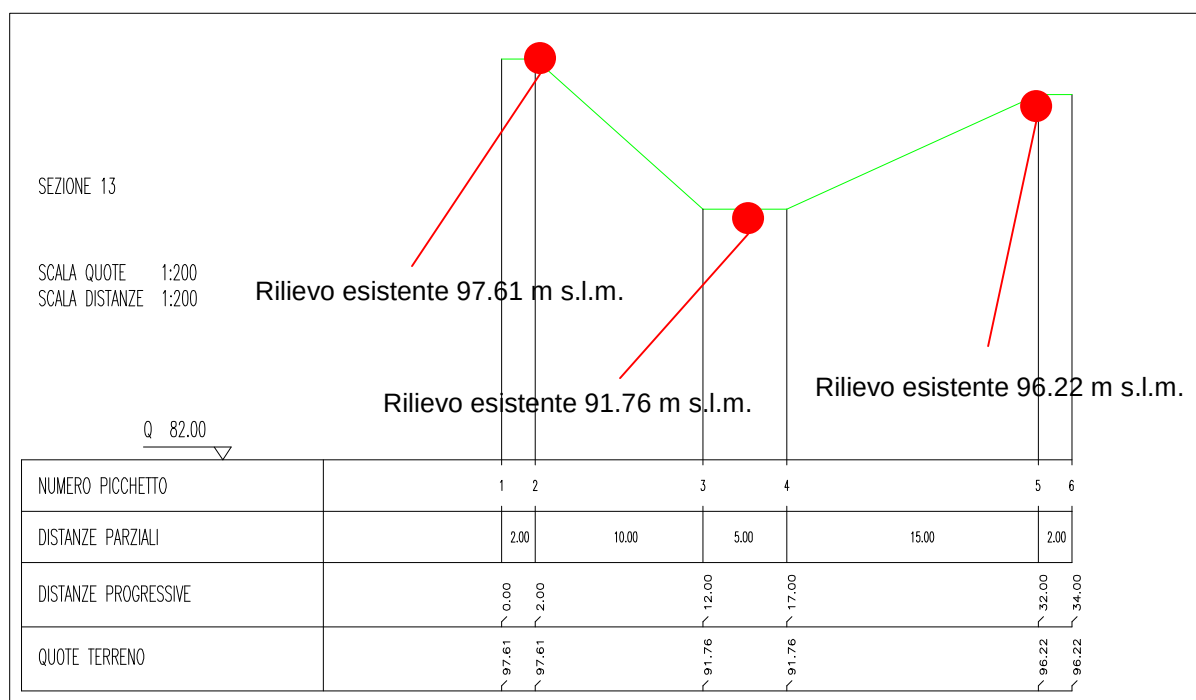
Torrente Foci, Sez. F 13 (sezione da rilievo esistente)
